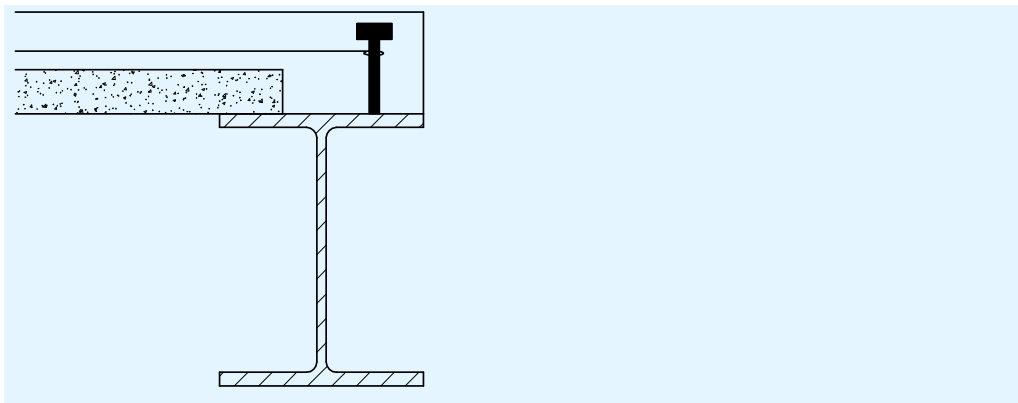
Conexiones posibles entre la placa de hormigón prefabricado y la estructura de acero para asegurar la acción de diafragma del forjado.
